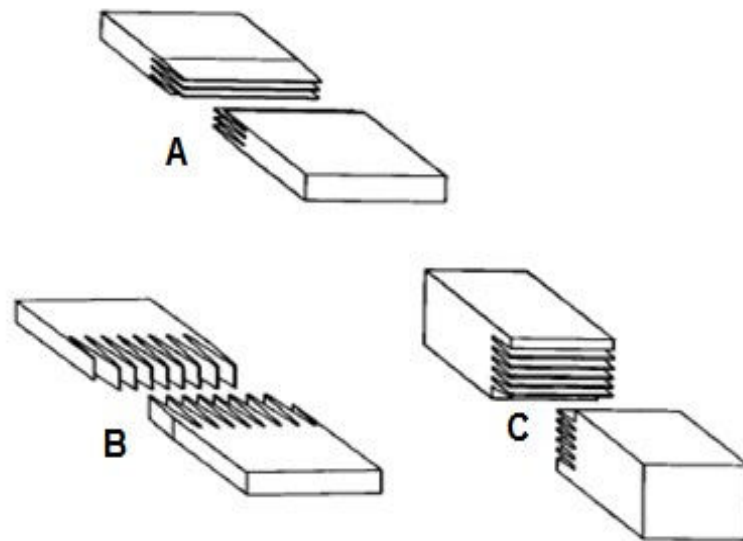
Emendas dentadas para uniões finger joint A- Finger joint estrutural horizontal. B- Finger joint vertical estrutural, C-Finger joint não estrutural
